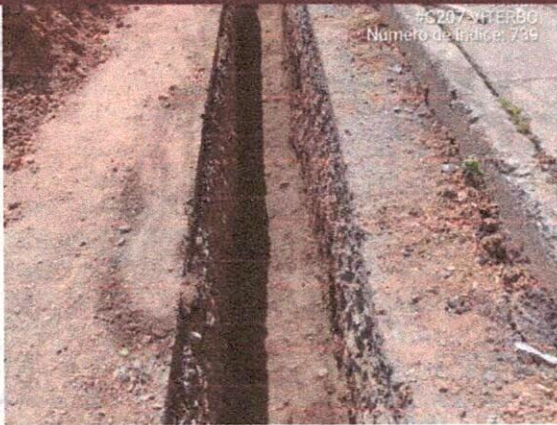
y 6: Retiro de material sobrante de demolición y empalme de tubería en calle 7 con carrera 8.
